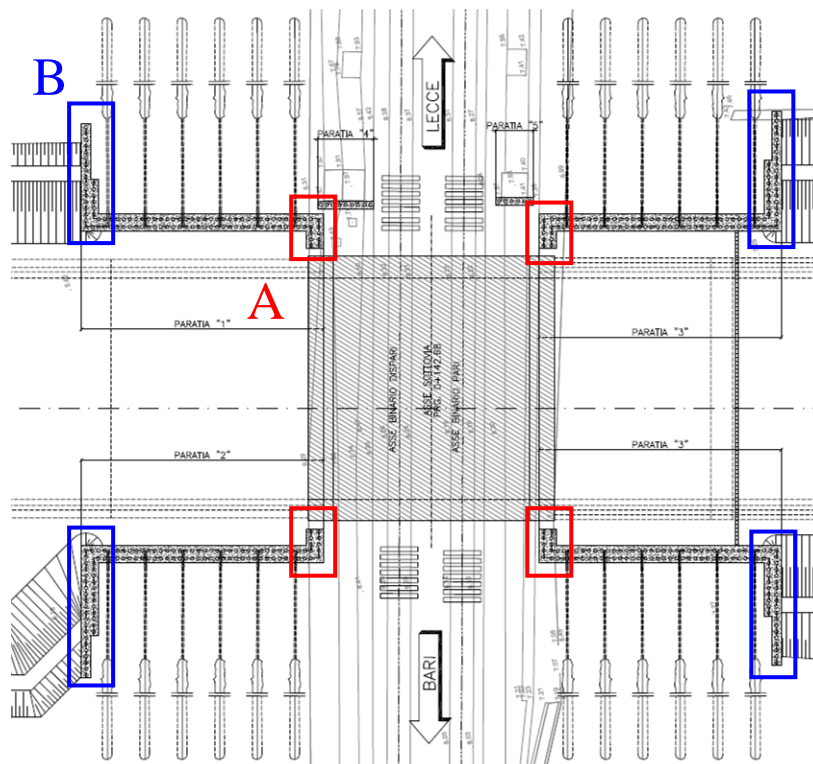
Stralcio planimetrico con ubicazione paratia di micropali
